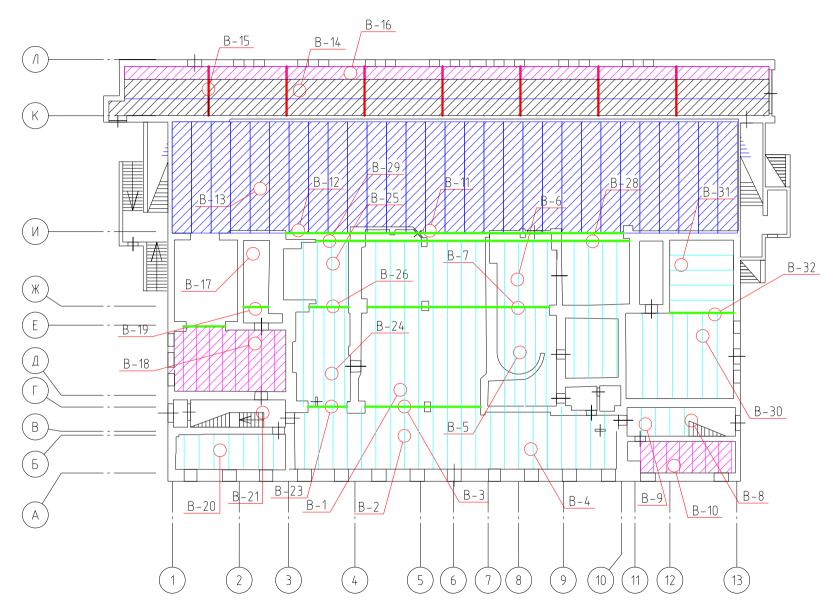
Схема участков вскрытий над первым этажом с раскладкой плит и балок.
